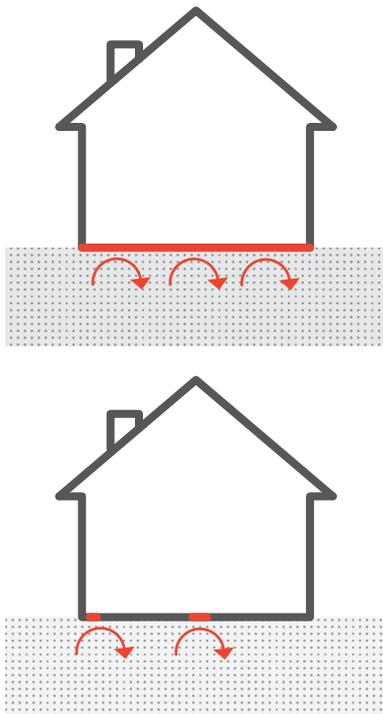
Barrera de protección frente al radón (arriba) y sellado de fisuras, grietas, encuentros y juntas (abajo)
